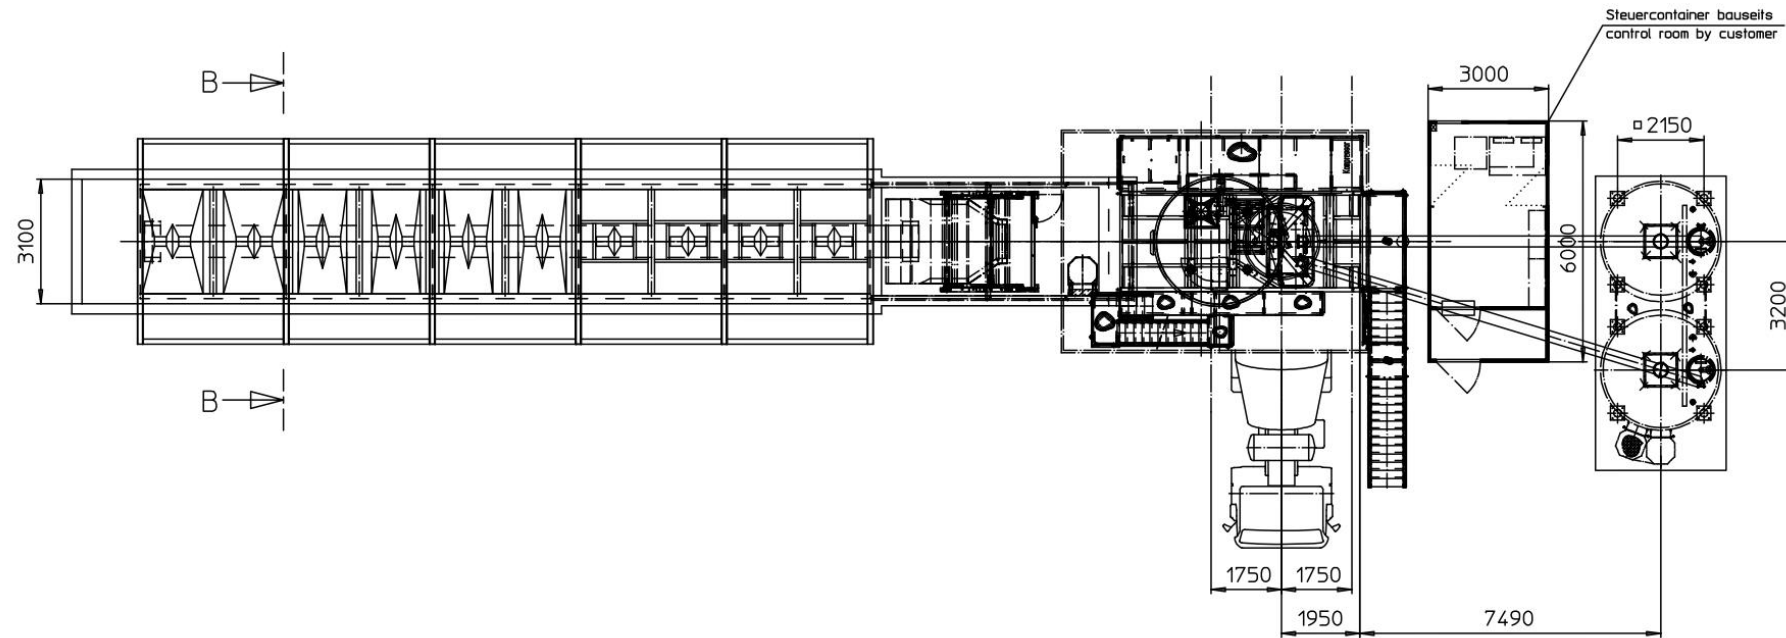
/2. Situacijski nacrt – planirano stanje [22]
